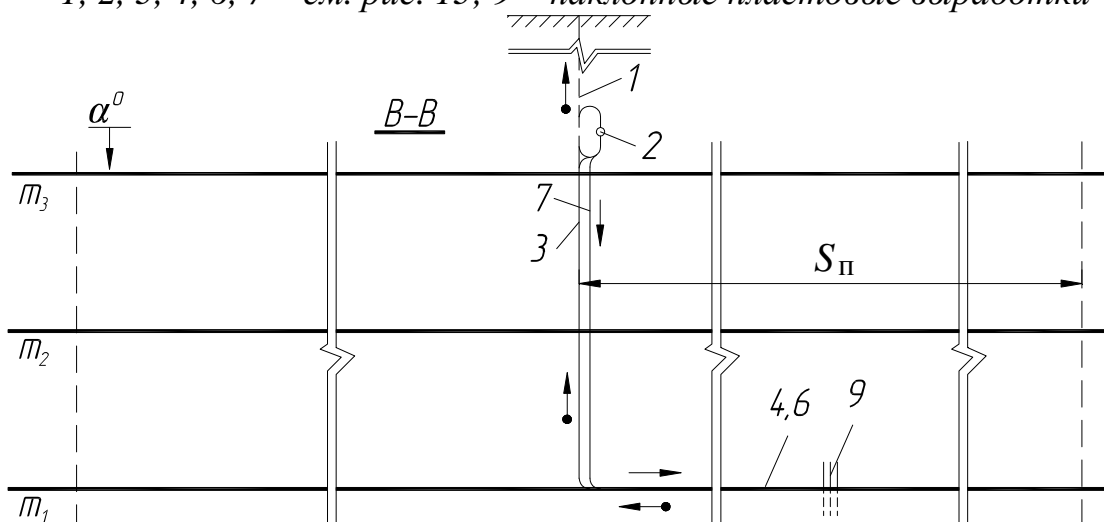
Индивидуальная пластовая подготовка при комбинированной схеме вскрытия с капитальным квершлагом:
